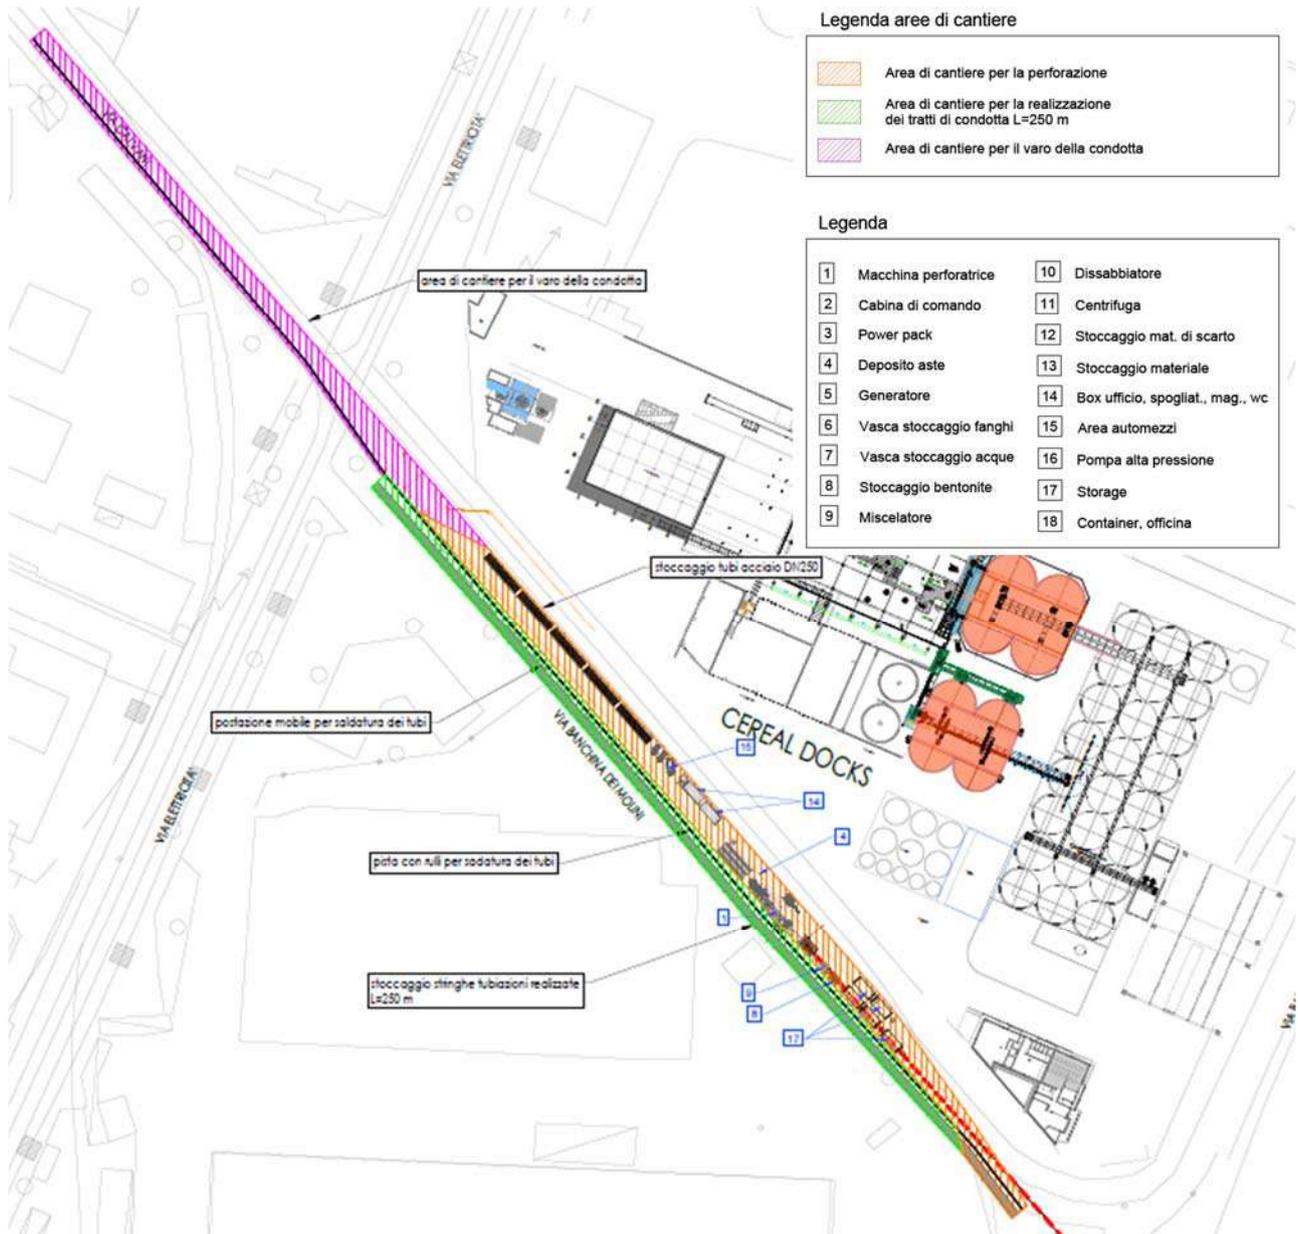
Cantiere lato Ovest – sistemazione delle aree - sito Banchina Molini, via Galvani
